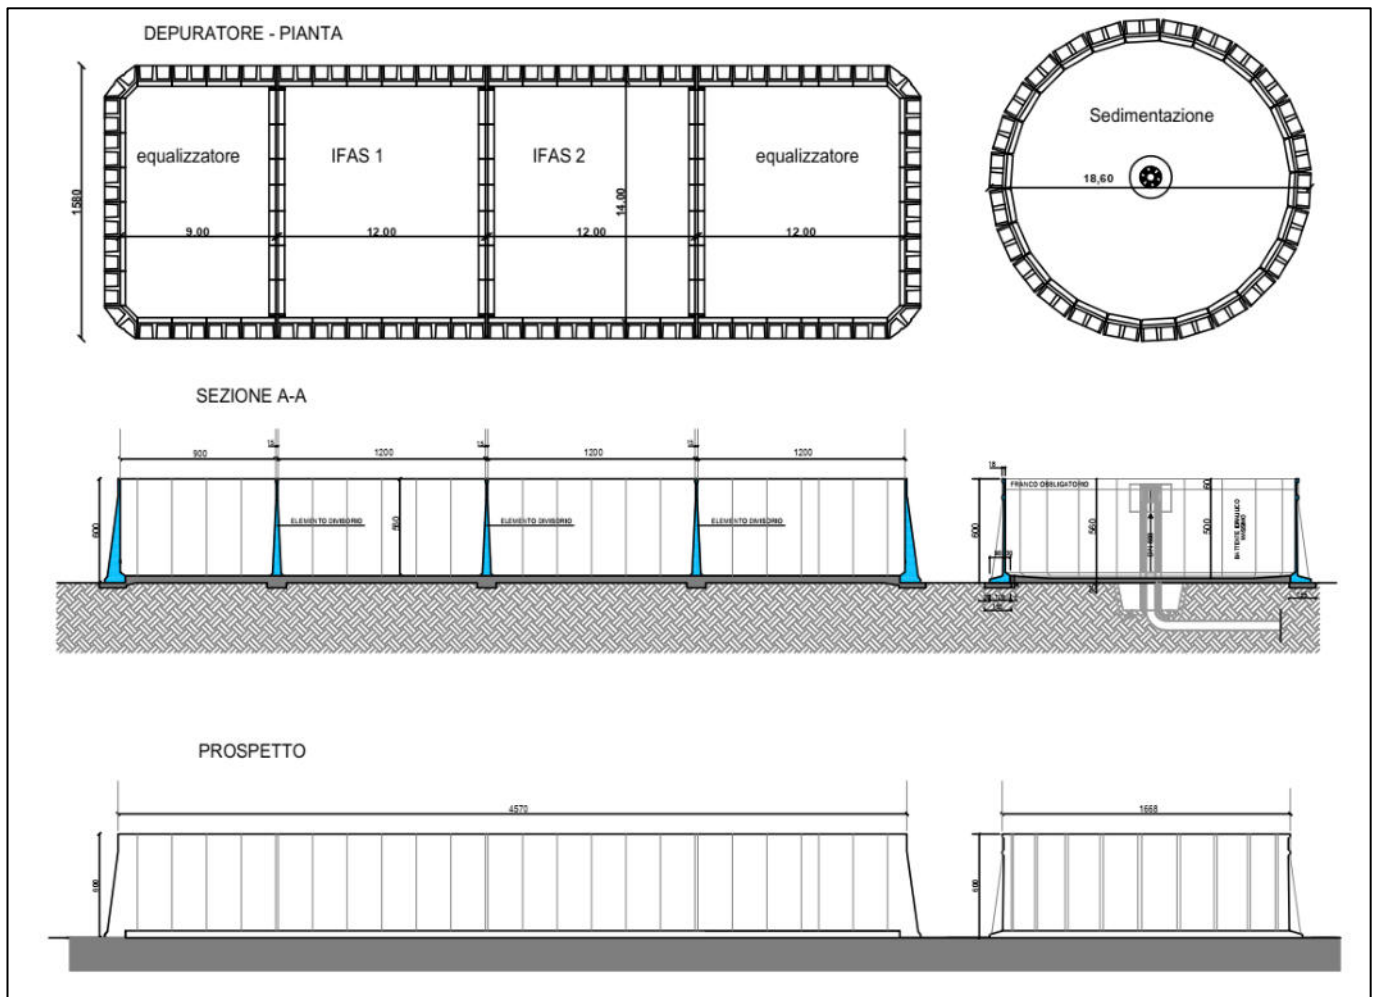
Pianta, prospetti e sezioni vasche ossidazione biologica e sedimentatore secondario
